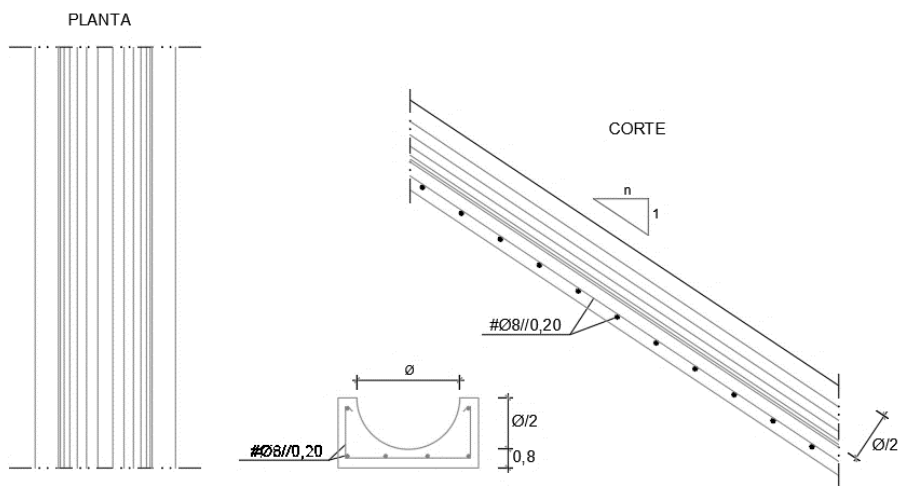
Planta, corte e secção tipo de descidas de talude semi-circular em betão (IEP, 2001)
